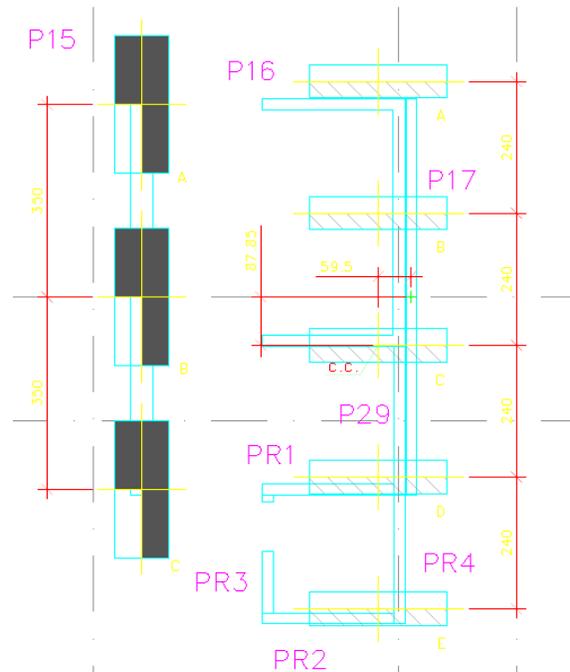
Detalhe da nova solução de fundação para 2 pilares
